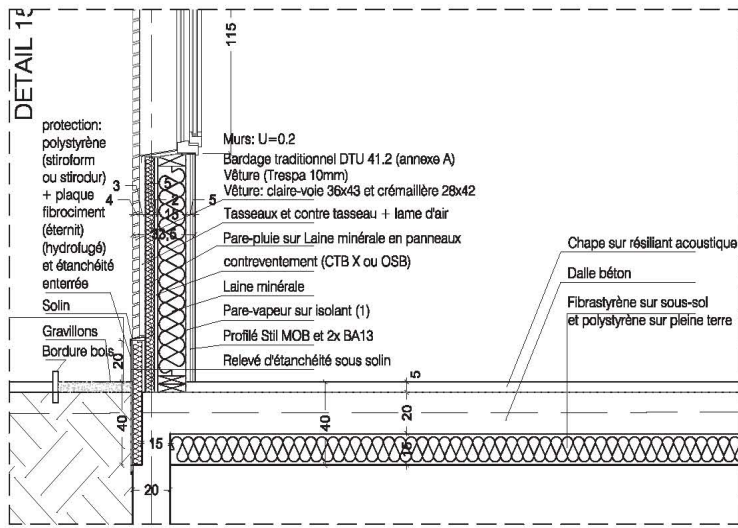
DETAIL DE PRINCIPE D'ACROTERE, DE SOUBASSEMENTS ET DE PLANCHER INTERMEDIAIRE - D15
